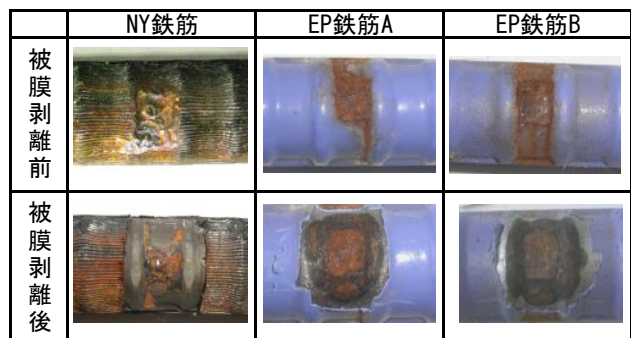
耐食性試験 60 サイクル終了時の腐食状況
